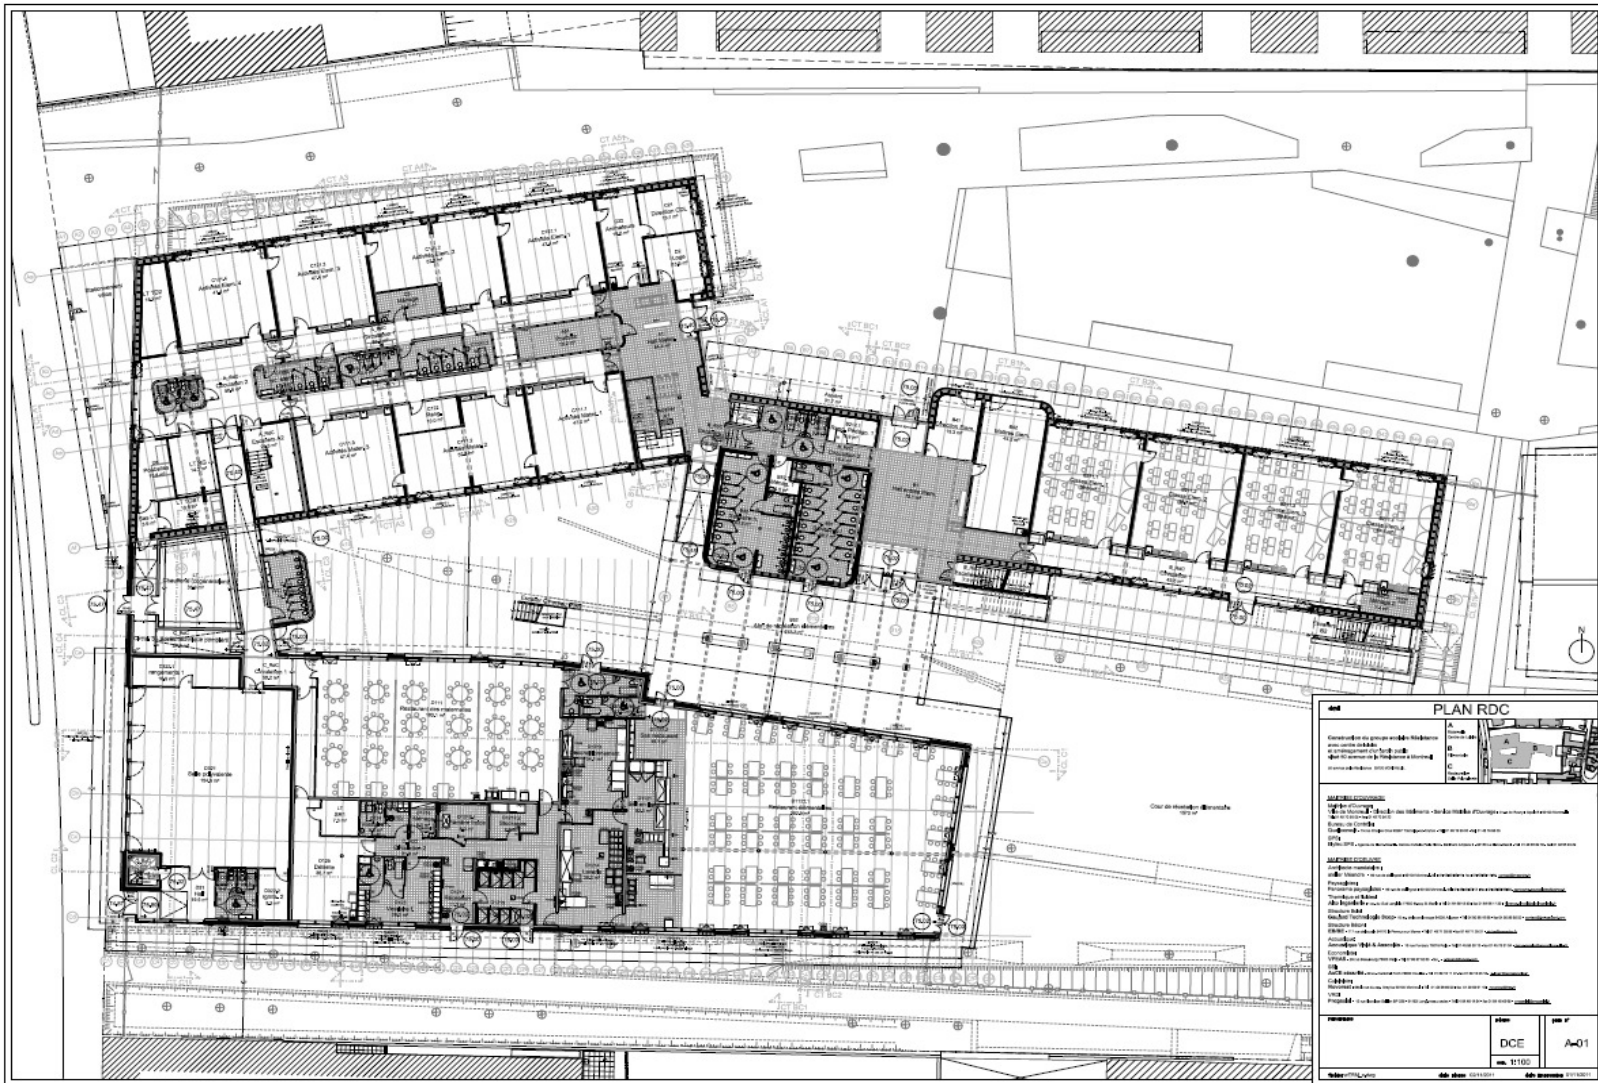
PLAN DU RDC DU GROUPE SCOLAIRE "RESISTANCE" A MONTREUIL
